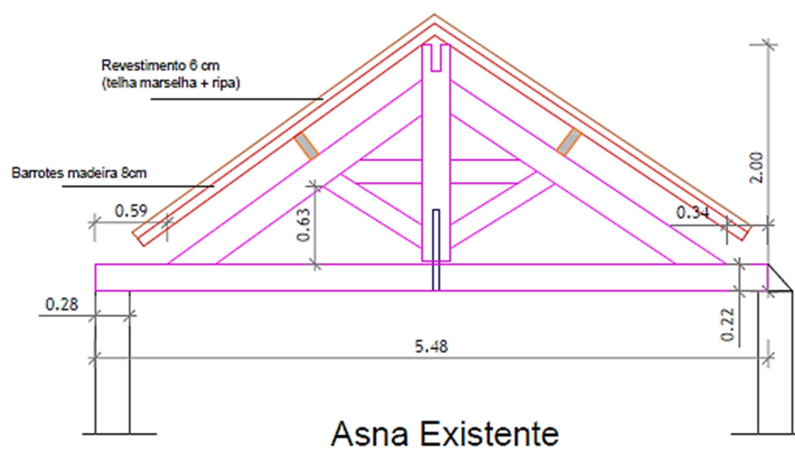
Desenho esquemático do levantamento de asna em obra
